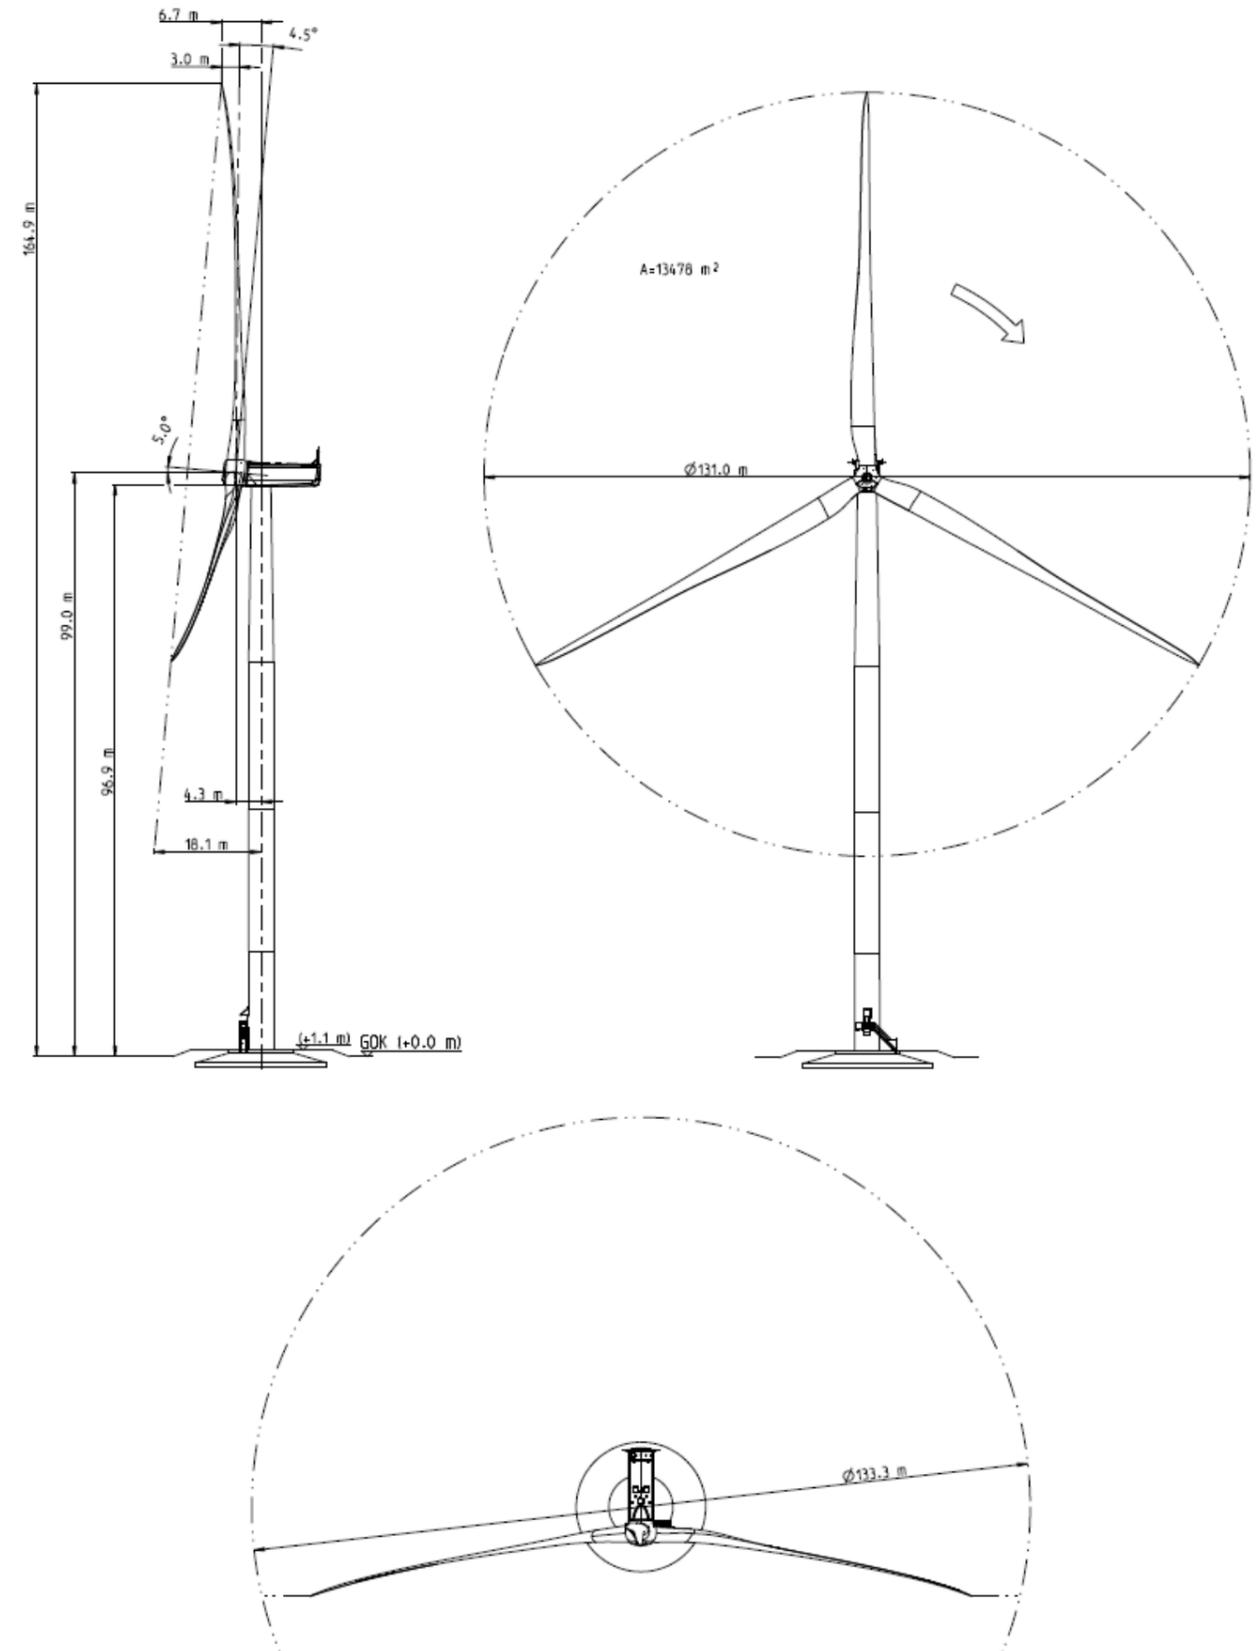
Plan d'élévation d'une éolienne N131 – 3,6 MW – 165m
